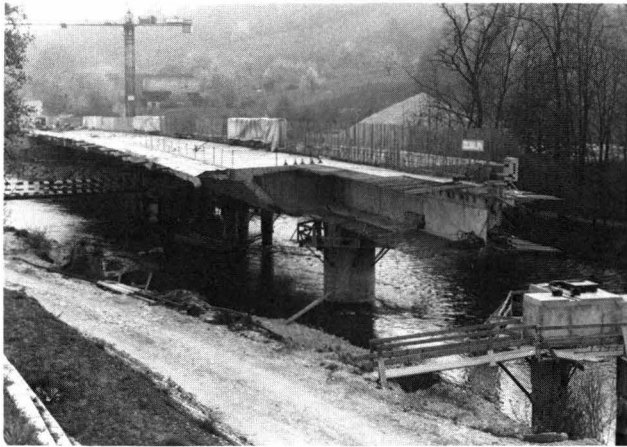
Vorbau schnabel aus Beton – Avant bec en béton – Concrete launching nose
